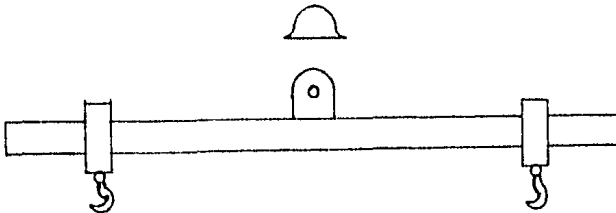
Balancín ocupado en el montaje de los paquetes.
